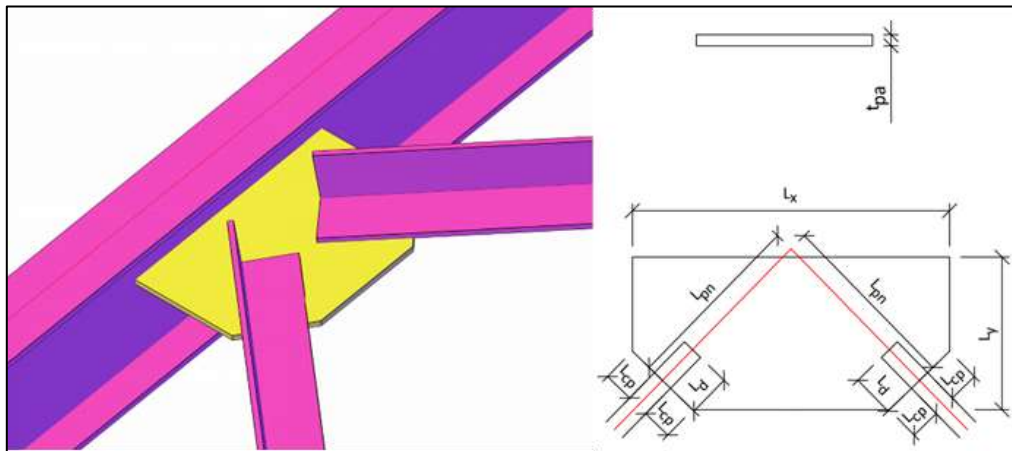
Conexión a corte Doble Techo (Perfiles: alma llena)
